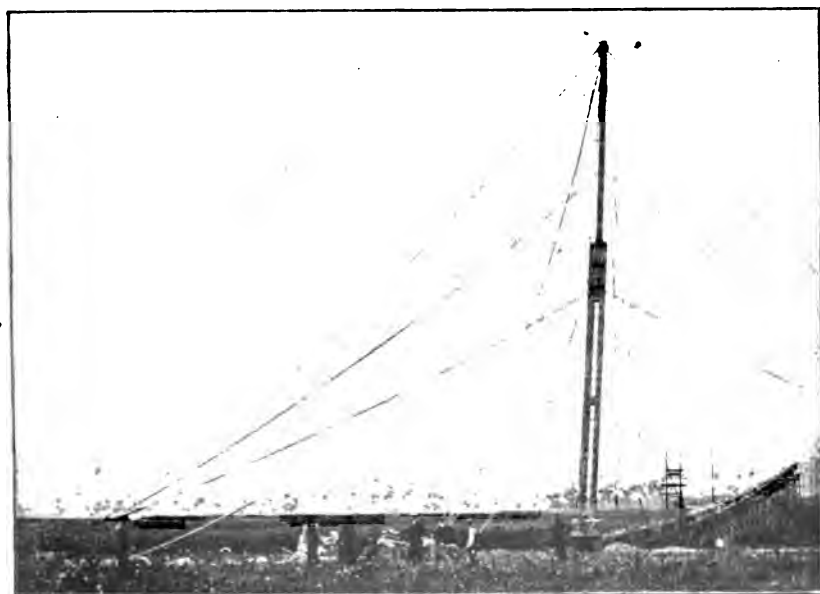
Der 360 Fuß (engl.) hohe Mast mit Hilfsmast für Aufrichtung.
